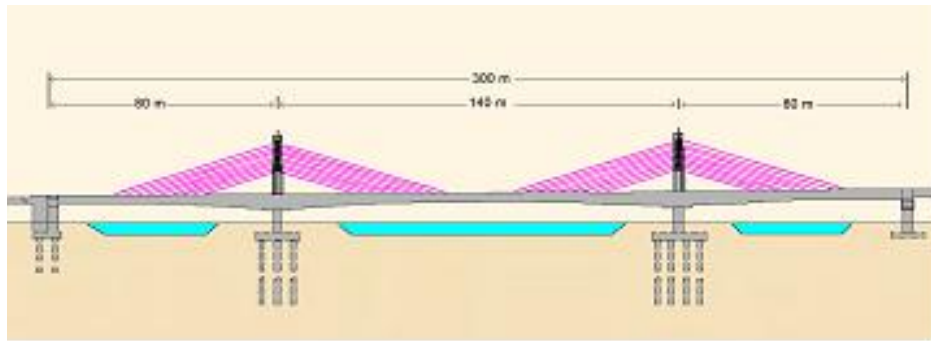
Puente de hormigón con preesforzado extradadosado. Puente de Nankang River, Taiwán (2007).
